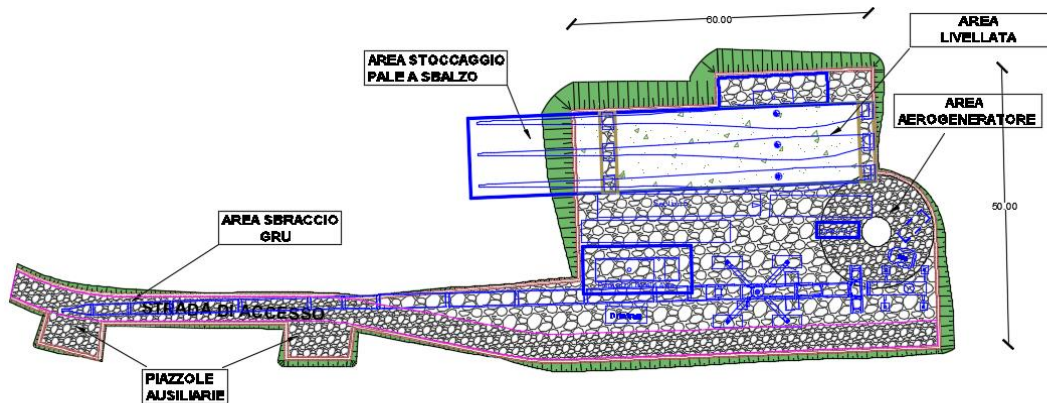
Planimetria piazzola tipo in fase di esecuzione lavori
